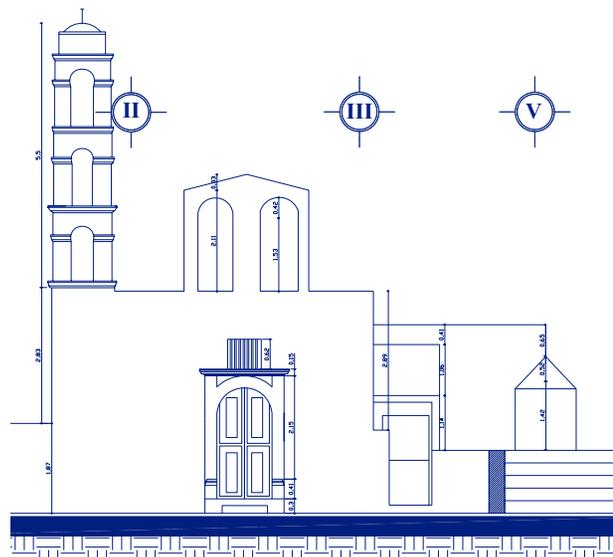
Fachada principal de la capilla, se aprecia la torrecilla que aparentemente esta adosada al muro
